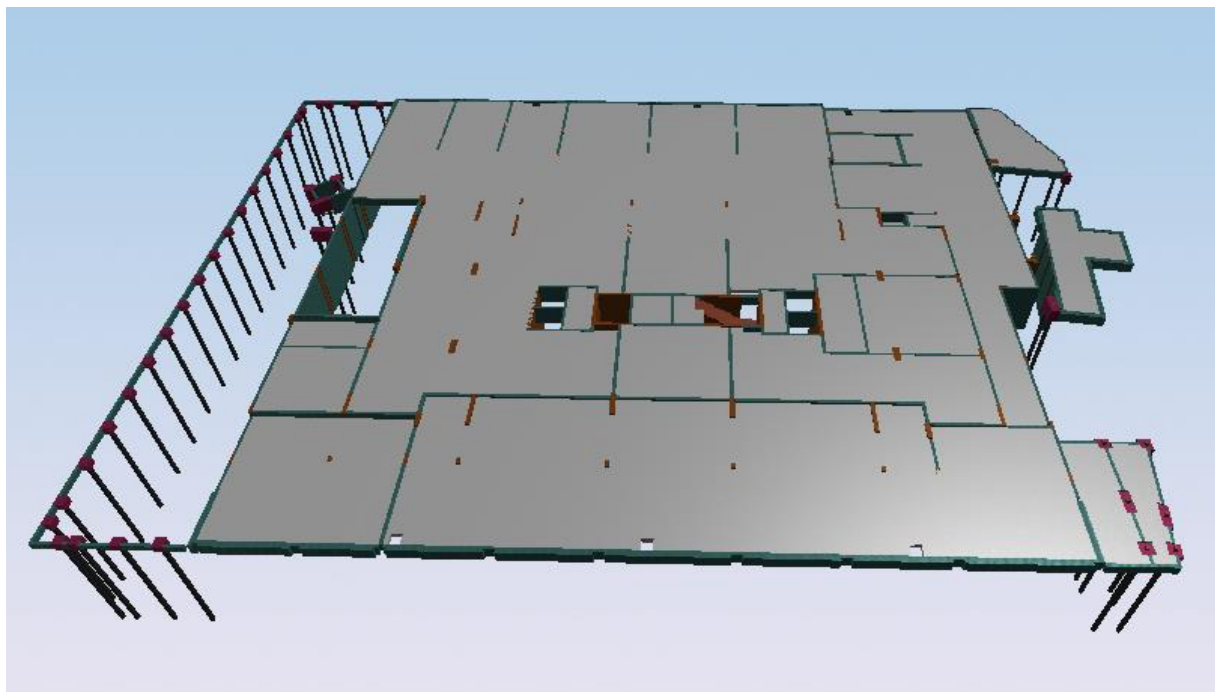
Imagem 3D da solução em laje nervurada para o pavimento térreo.
